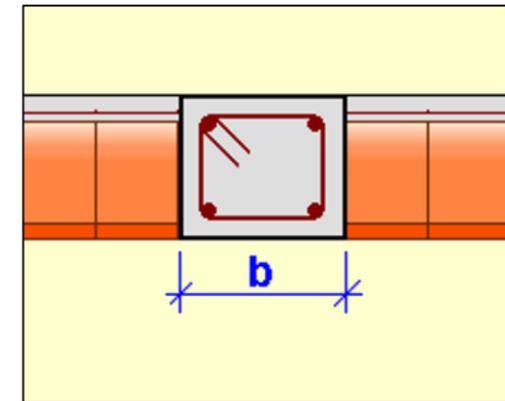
Sección tipo viga plana rectangular. Fuente: CYPE
